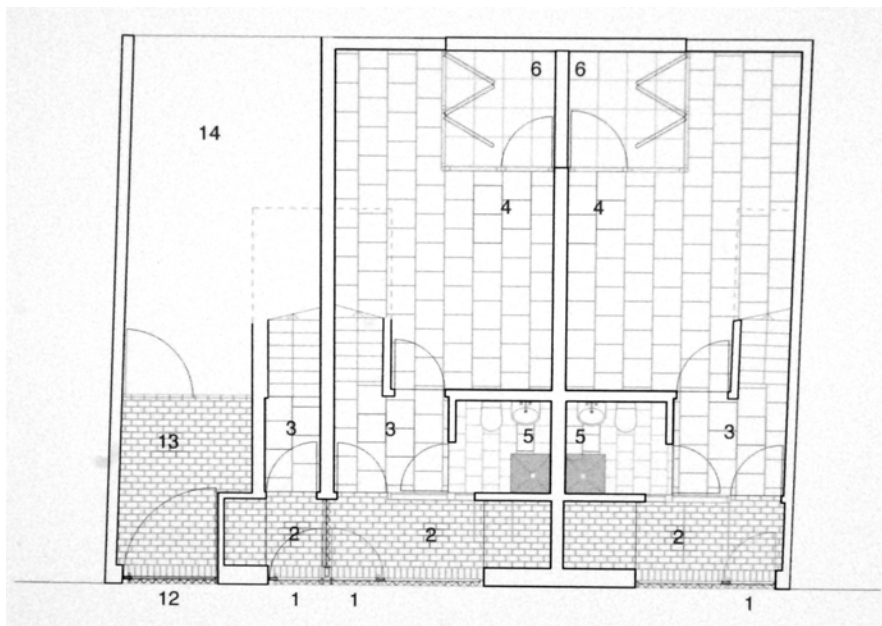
Artefact plan du rez-de-chaussée (*T3_ple1*)⁴
